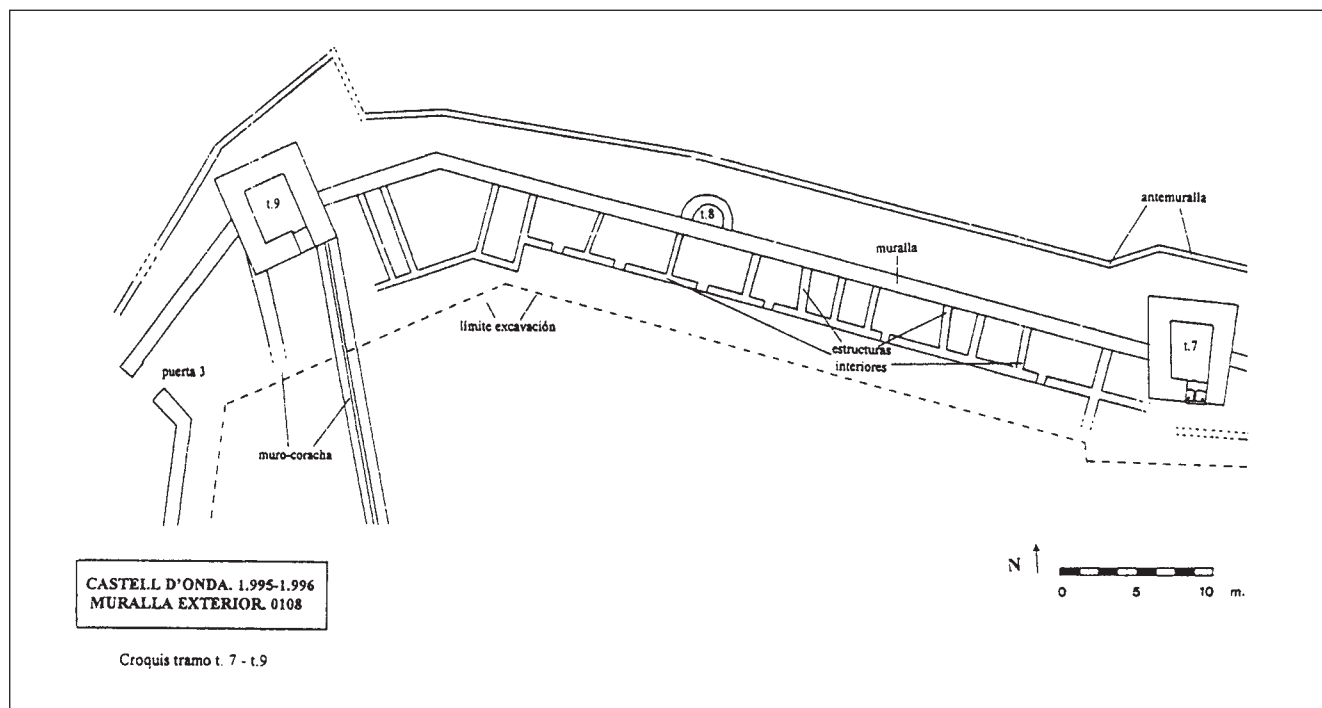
Planta de las estructuras celulares de la muralla exterior del Castell d'Onda excavadas en 1995-96 (Alonso, Estall y Raga, 1995: 25).
